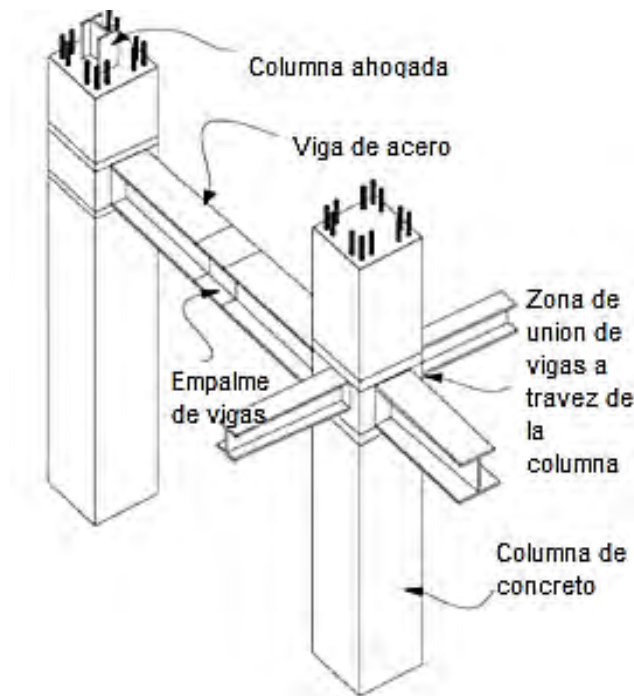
Ejemplo de vigas de acero columnas de concreto (Mehanny y Deierlein 2000).
